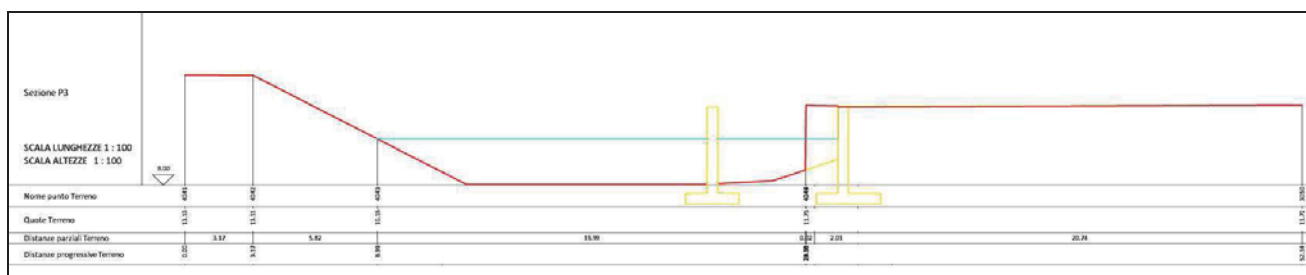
Sezione trasversale tipo in corrispondenza della Cavana, in rosso è evidenziata la sezione esistente mentre in giallo la sezione di progetto.
